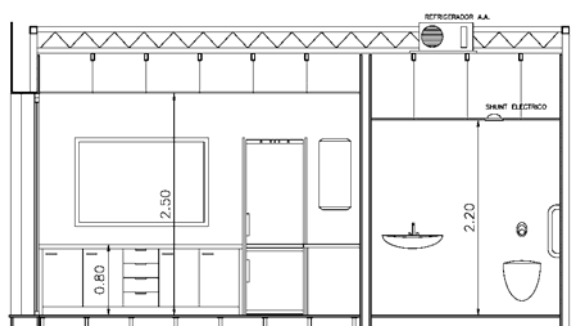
Vista en alzado de la cocina y baño del *Living-Lab Valencia*, con detalle técnico de suelo y falso techo.
